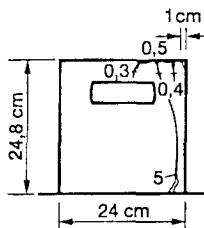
Rissbildung im Bruchzustand an einem Auflagerstein aus Porenbeton
